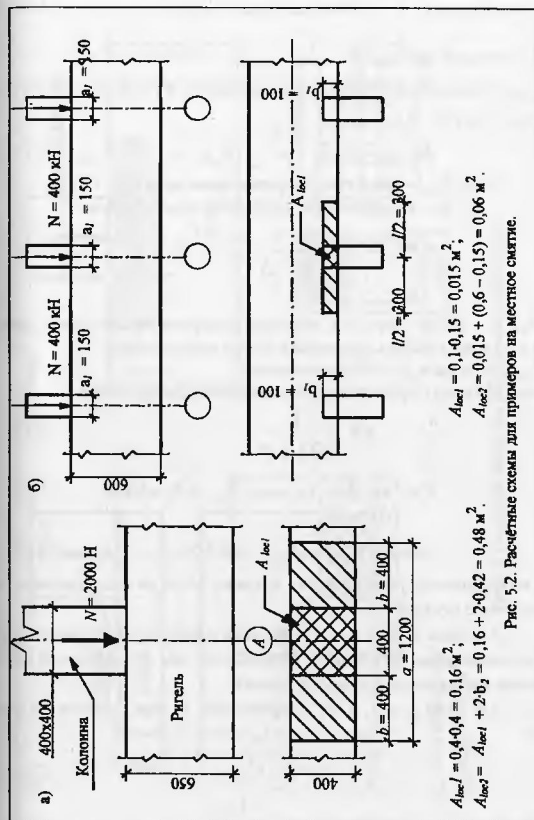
Расчётные схемы для примеров на местное сжатие.
